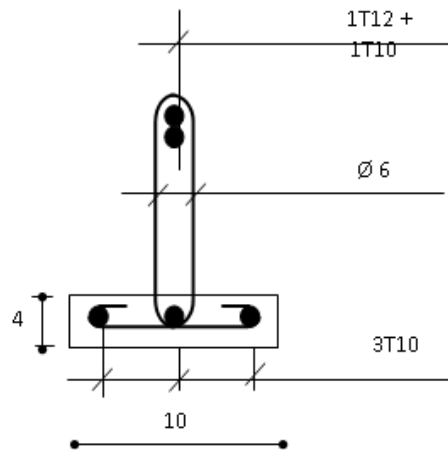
Ferraillages de la poutrelle (sur appuis)
